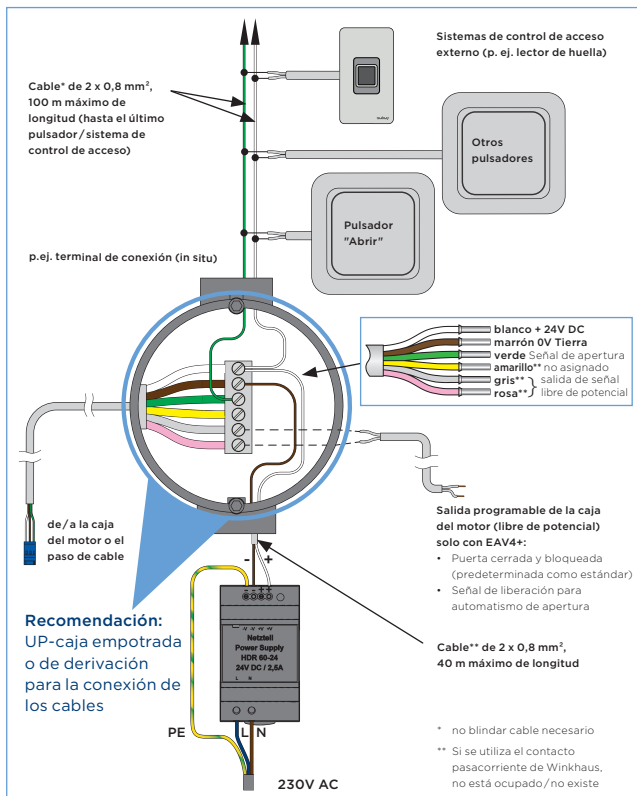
Plan general de conexiones (con fuente de alimentación de perfil DIN y paso de cable)
